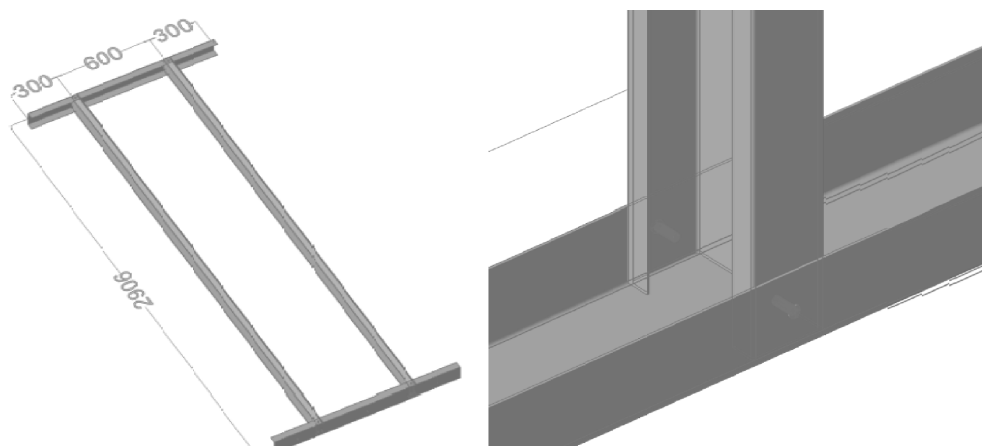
Sistema de parede L.S.F. (à esq.) ligação aparafusada entre as abas do perfil “U” e perfil vertical “C”
